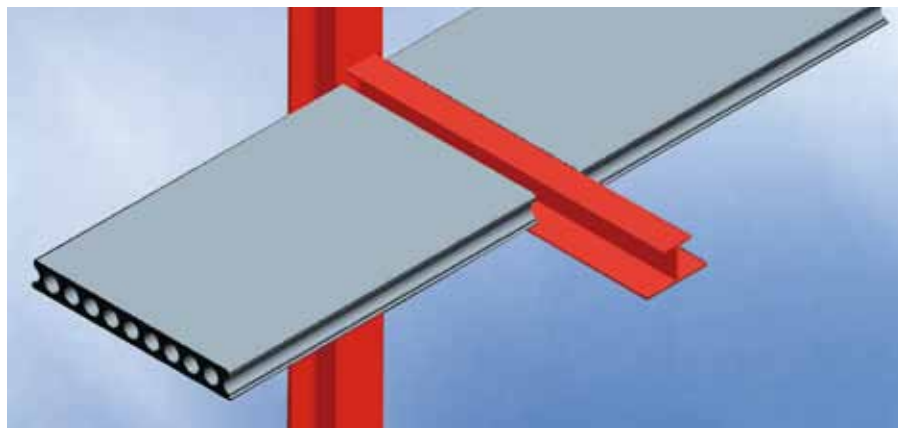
Forjado integrado de vigas asimétricas y losas prefabricadas de hormigón
